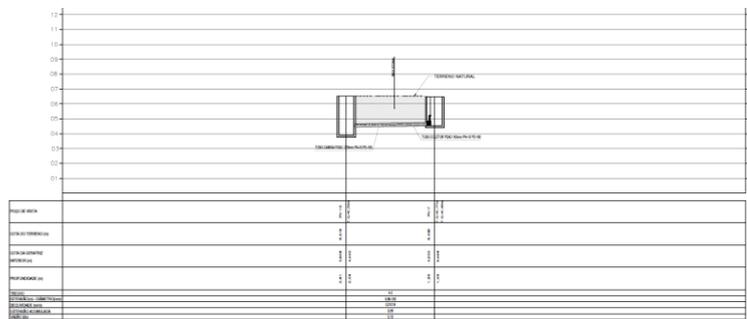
Perfil longitudinal da travessia SB-T05 - PV-7 ao PV-12
